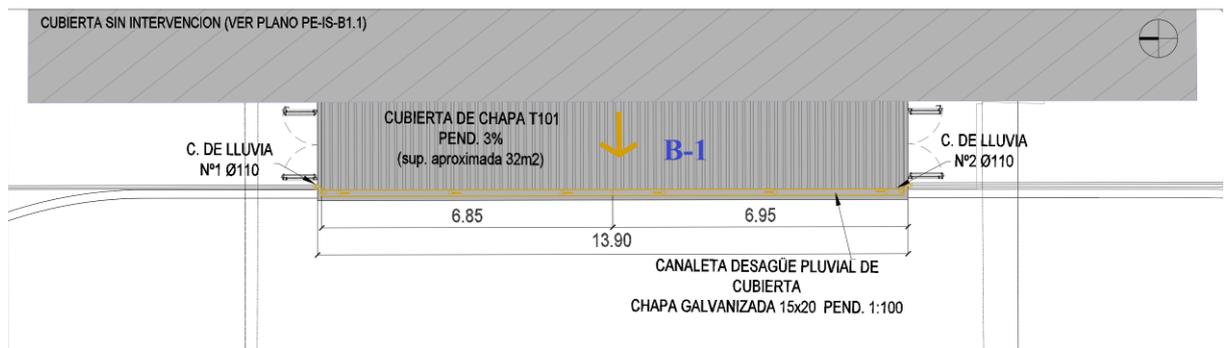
Planta de techos Edificio B1 a desaguar en paso fronterizo La Quiaca - Provincia de Jujuy
